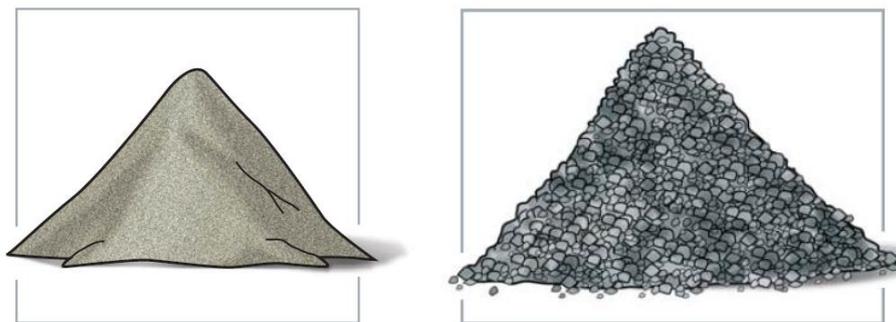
Arena gruesa y piedra chancada para dosificación de concreto.
